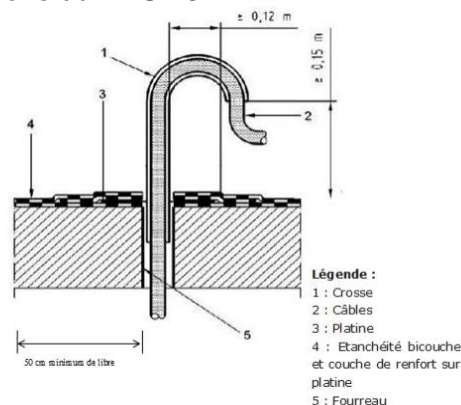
Crosse pour passage des câbles à travers la toiture.
